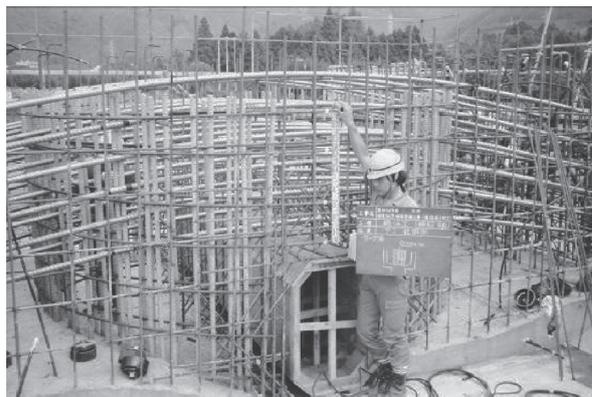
柱頭部横桁の施工状況 (建設時資料より)
